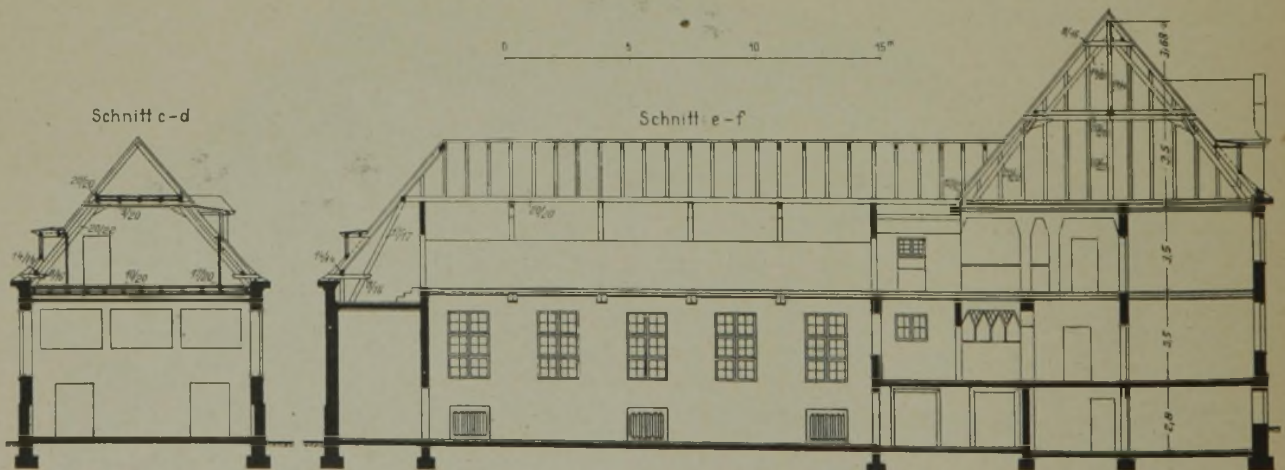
8. Schnitte in 1 : 300. (Vgl. Erdgeschoßgrundriß Abb. 9, S. 363.)
